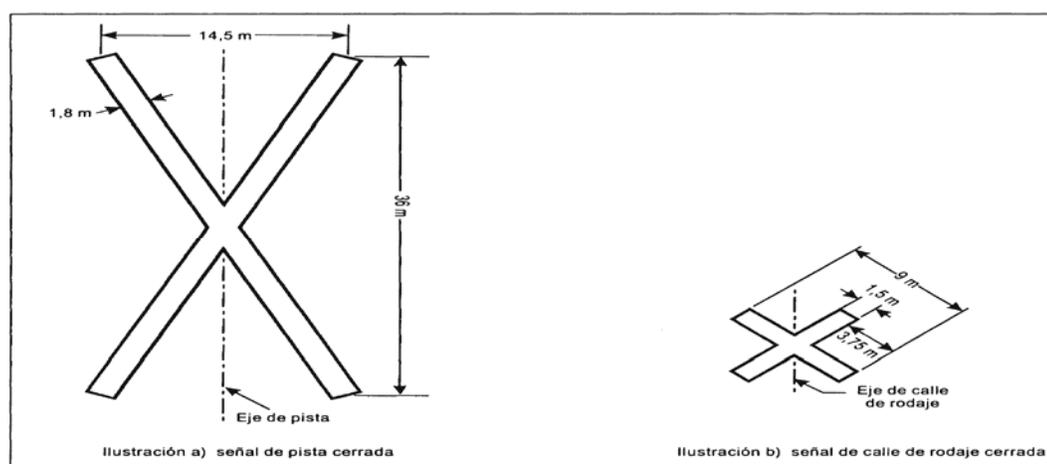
Señales de pista y de calle de rodaje cerradas
